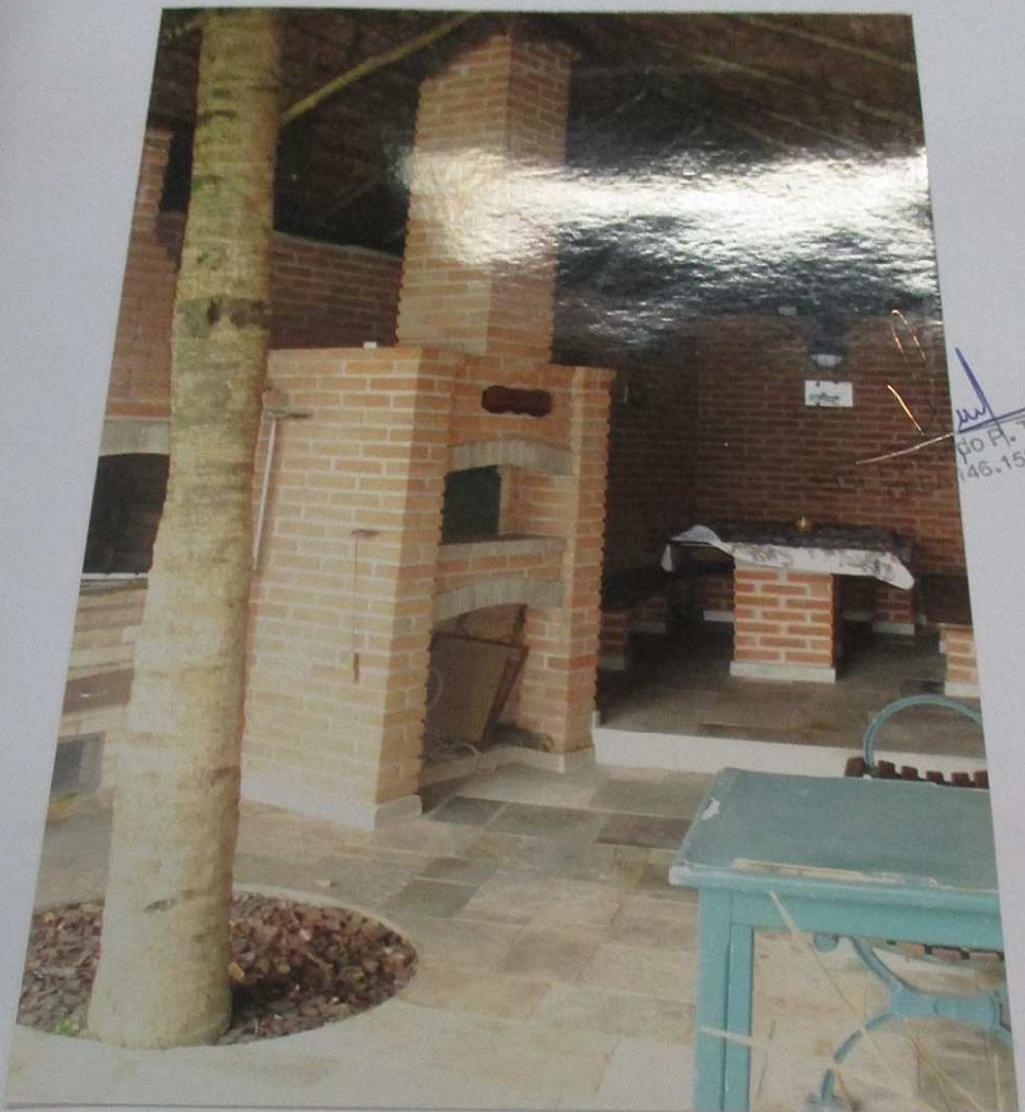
Vista parcial da churrasqueira; o piso é revestido com pedras “goiás”, as paredes revestidas com tijolos refratários.
